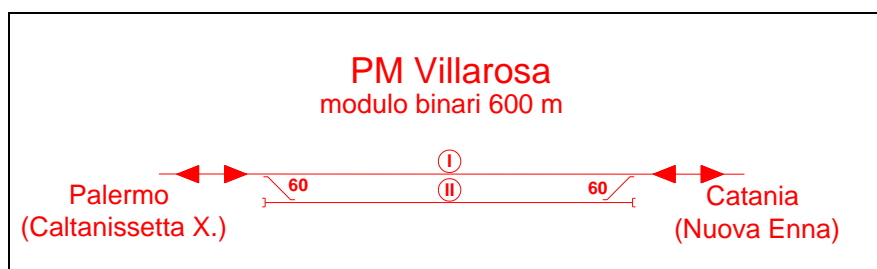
Layout funzionale di progetto – Nuovo PM Villarosa
